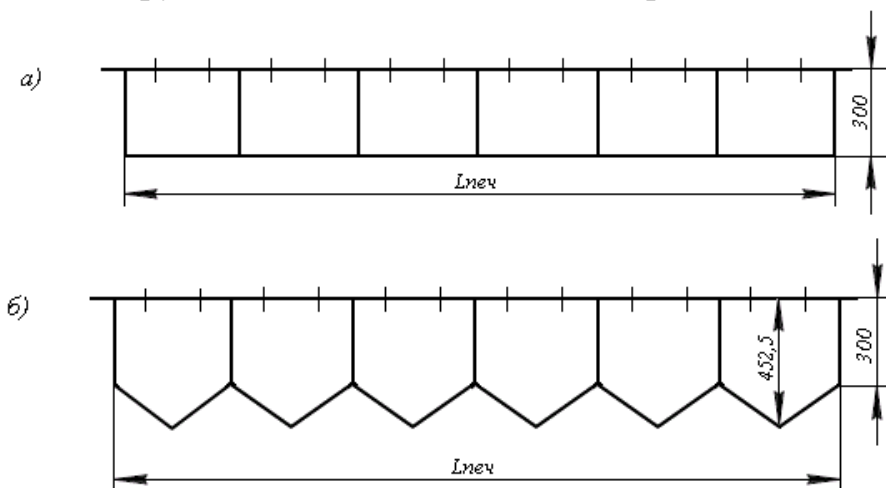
Схема конструкции свода: гладкий свод (а); пилообразный свод (б)
